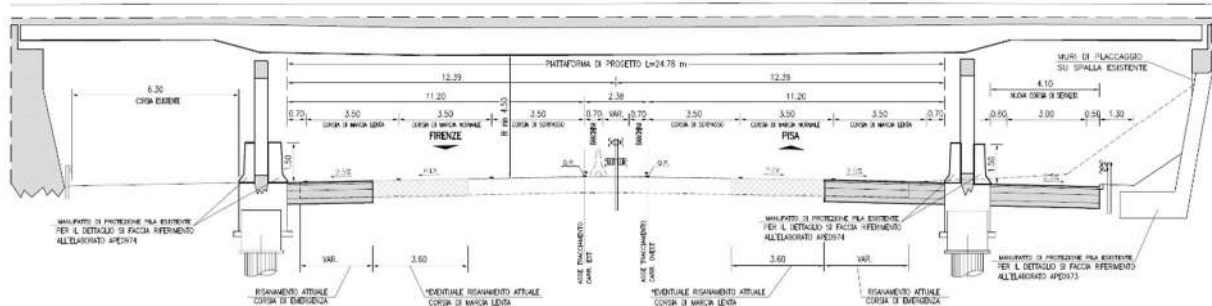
Sezione tipo con corsie ridotte in corrispondenza del cavalcavia Autostrada A1 al km 4+929
